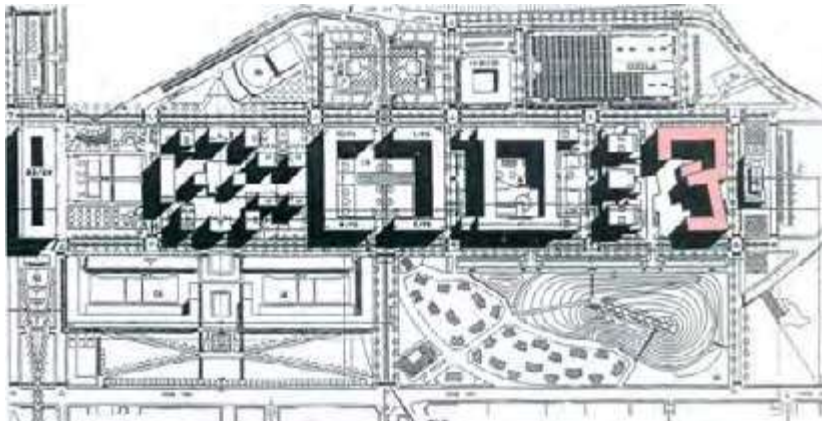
| Il masterplan del progetto “Bicocca” nella soluzione con la variante Deutsche Bank
